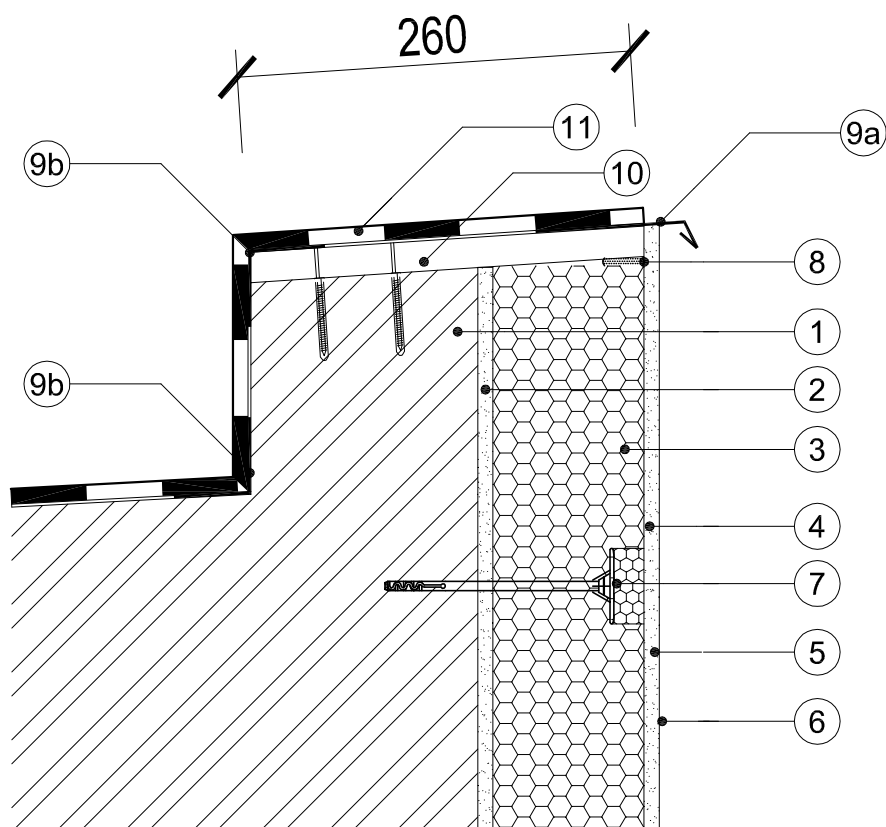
# DETAIL E (VZOROVÝ DETAIL - STYK U ZAPUŠTĚNÝCH OKEN A DVEŘÍ)
